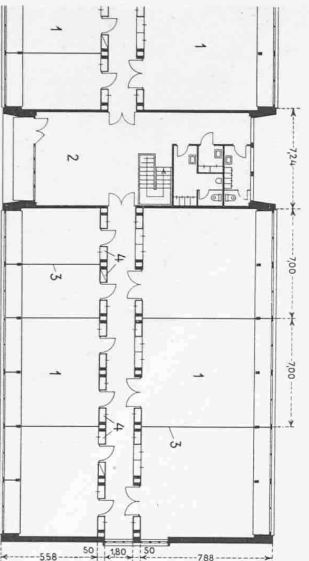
Laboratorien, Teilgrundriss 1:400. 1 Laboratorien; 2 Aufenthalts- und Diskussionsplatz; 3 Versetzbare Wände in Holz; 4 Schächte für Ventilation, elektrische und sanitäre Installationen
